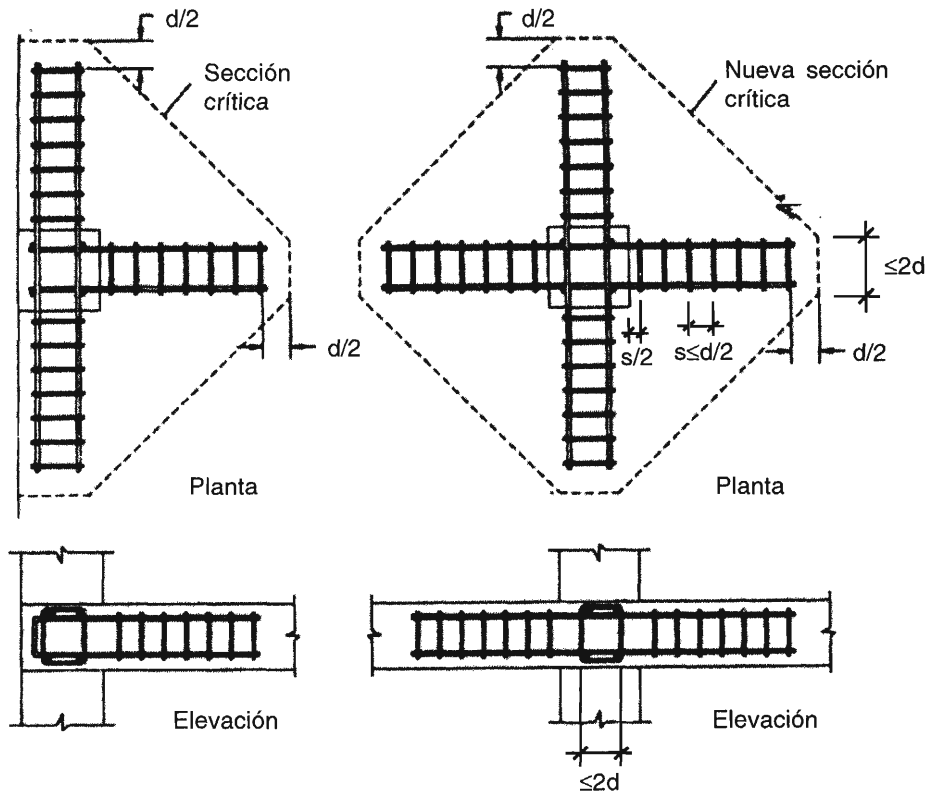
Refuerzo de corte en losas armadas en dos sentidos sin vigas
